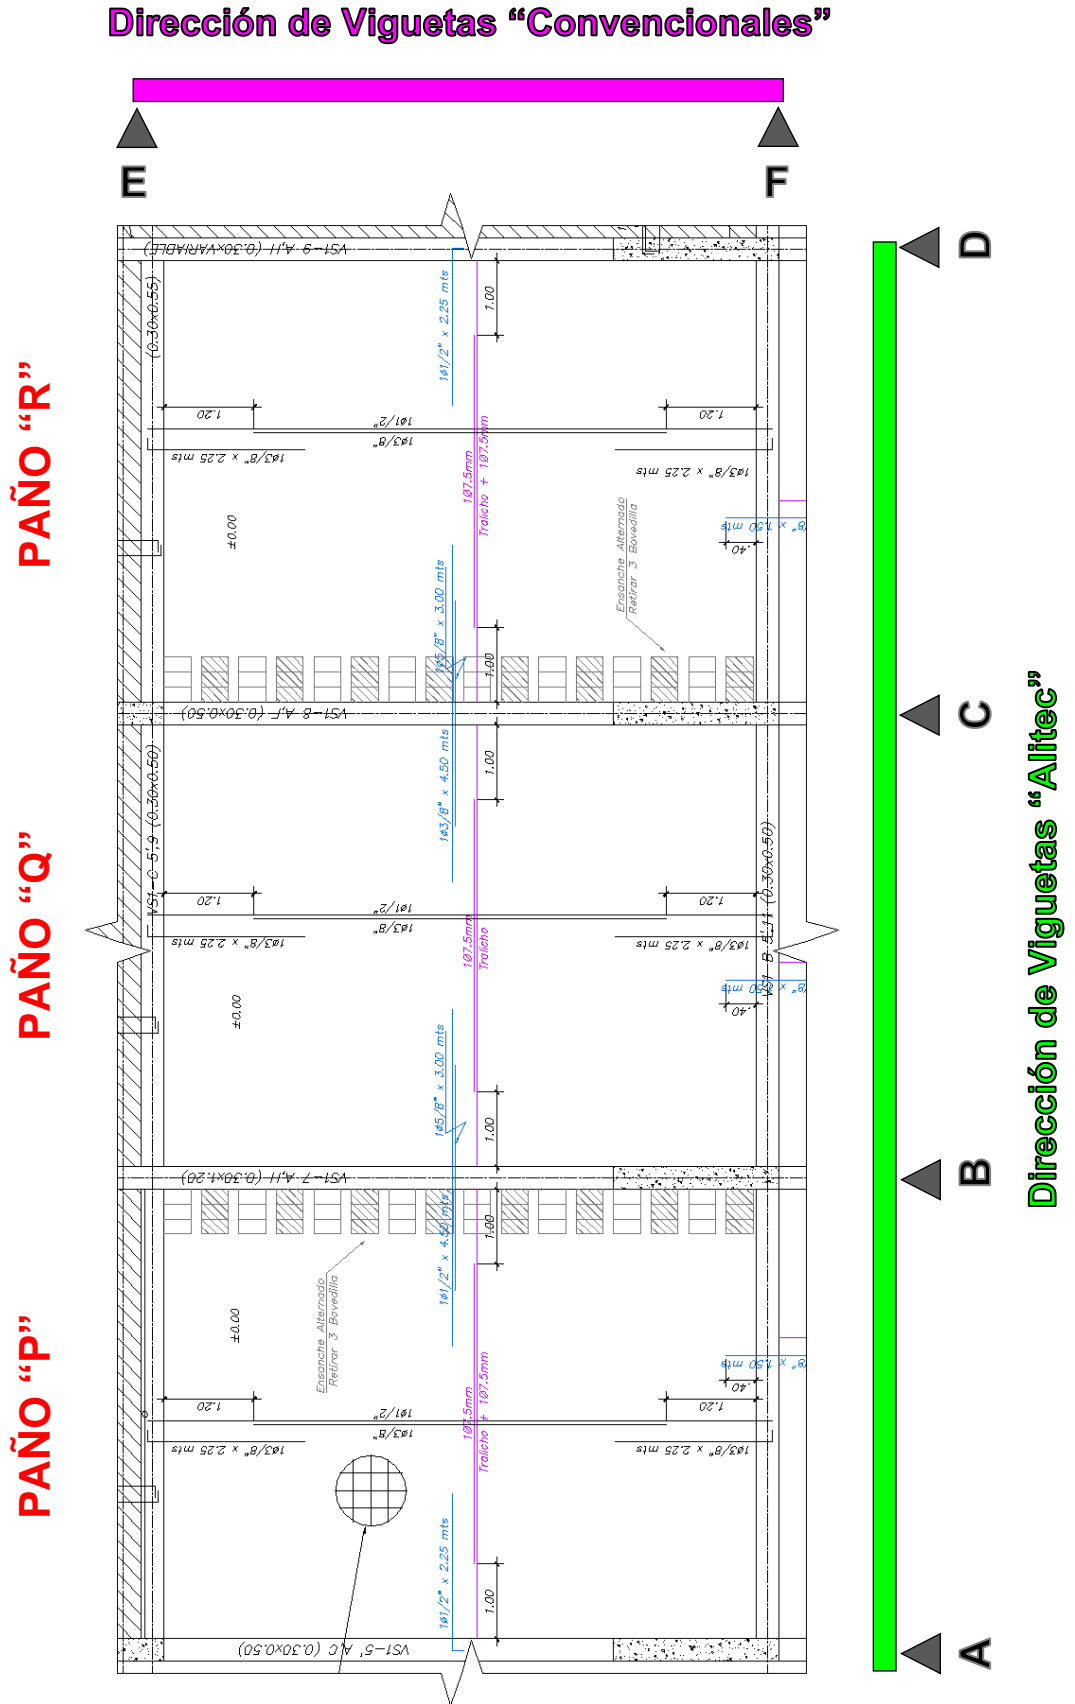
Plano de Encofrado Alitec del Sótano 1, comprendido entre los Ejes B – C/5' – 9' del Proyecto “Edificio Multifamiliar y Oficinas Privadas Don José”. (Ver Anexo 07)
